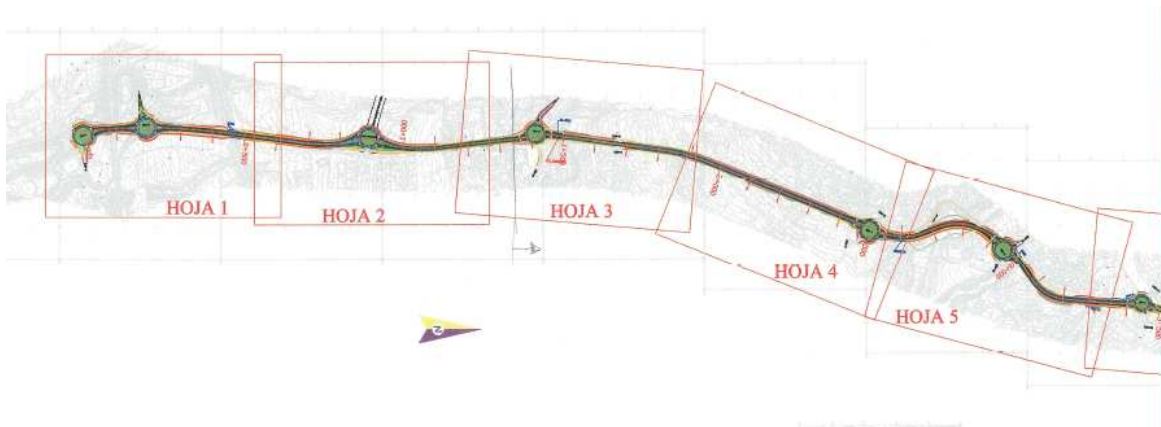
Extracto del plano 2.1 del proyecto “Acondicionamiento del itinerario Benidorm-Guadalest”
